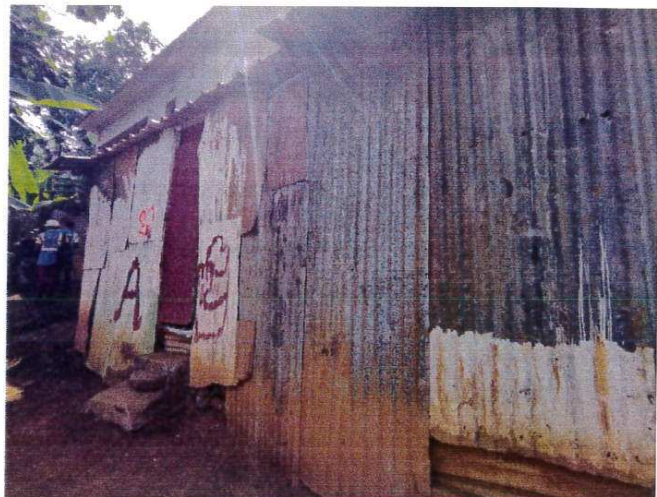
construction dépourvue de fondations, tôle clouée sur structure en bois.
